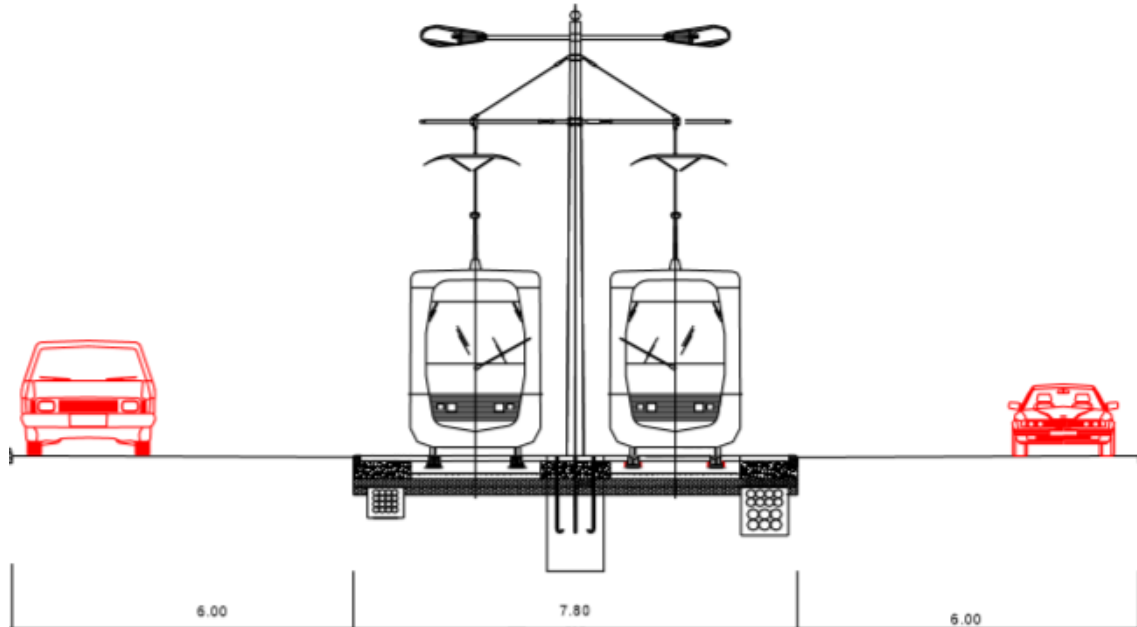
Ferrocarril metropolitano. Sección transversal
